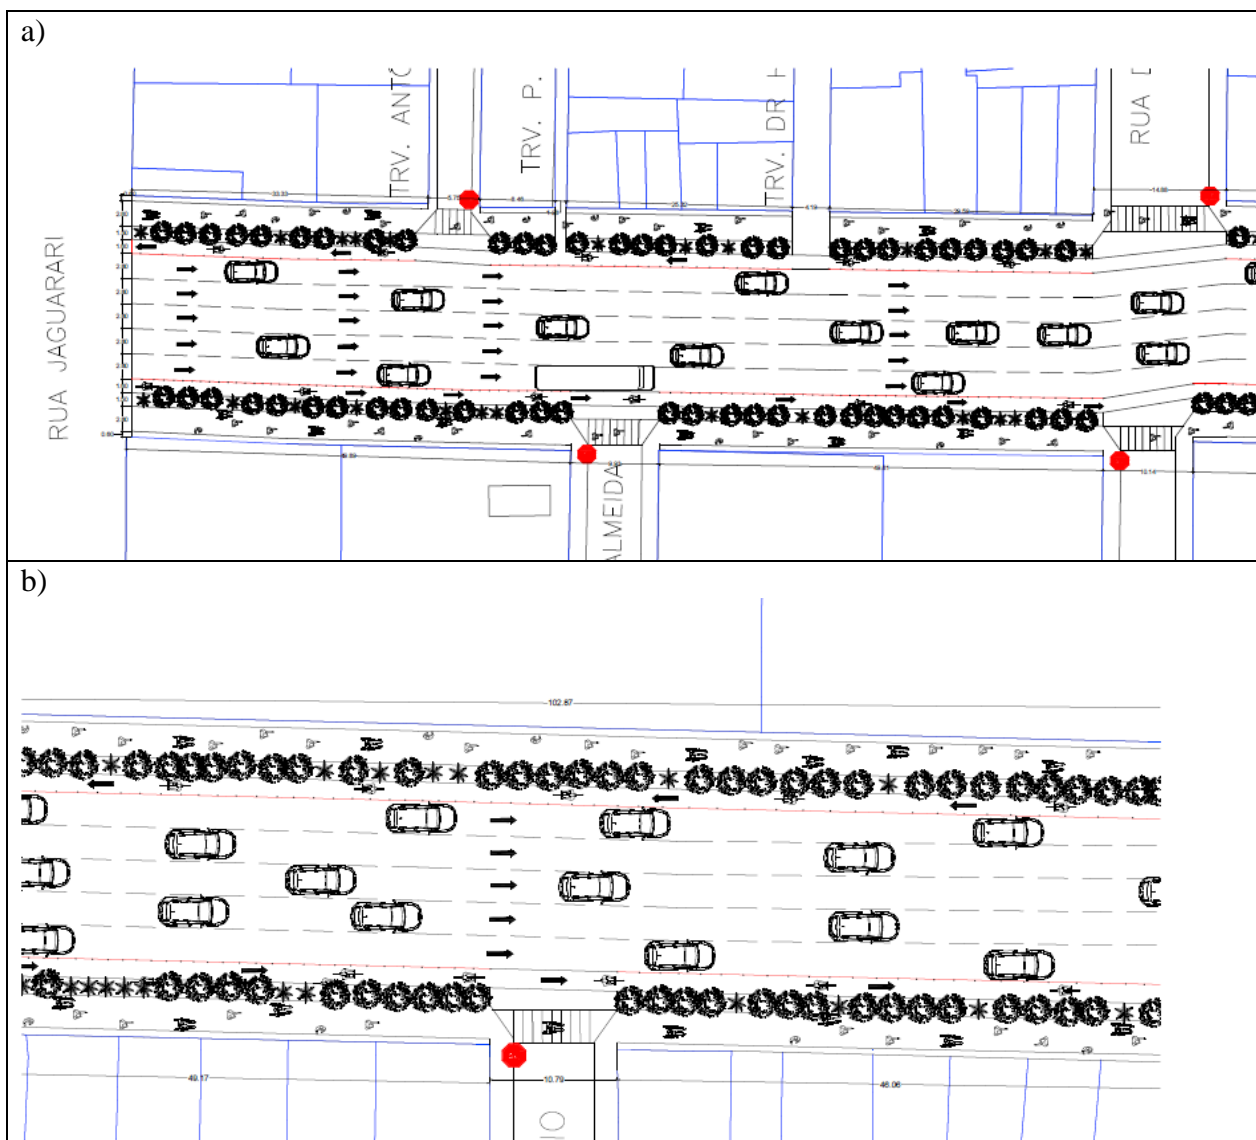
Planta baixa do trecho 1 do projeto dividido em 5 partes.
